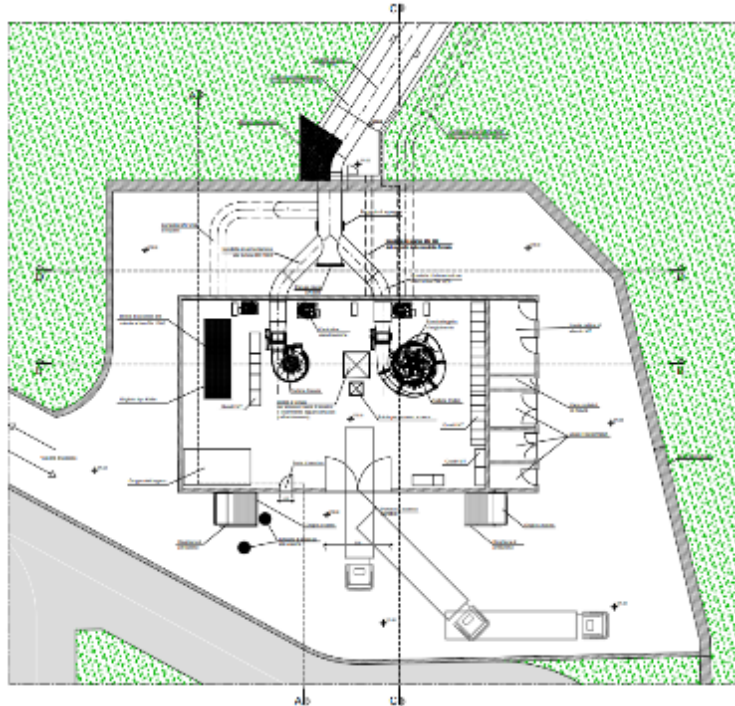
Disposizione in pianta dell'impianto idroelettrico
